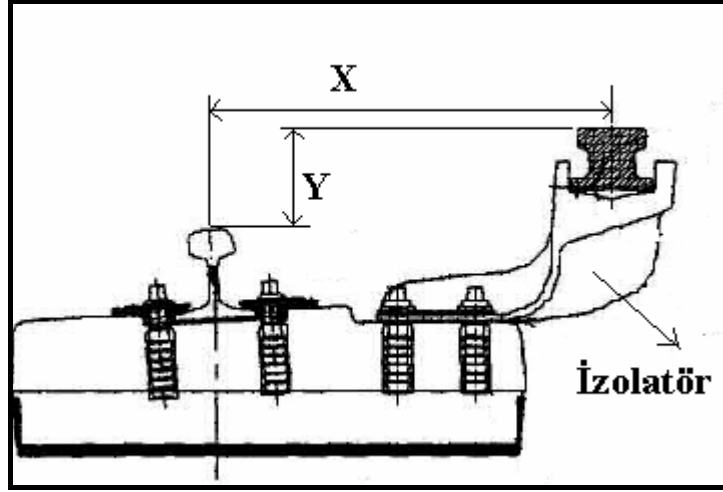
3.Ray Besleme Bağlantısı Takımı ve 3.Raya Montajı
